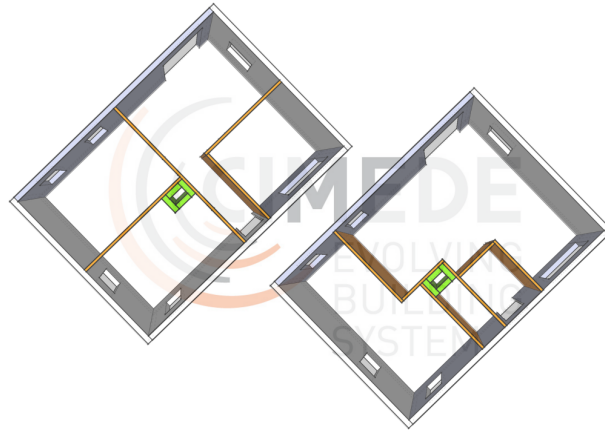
Projet CIMEDE [[www.atelier-de-lavenir.be](http://www.atelier-de-lavenir.be)]
